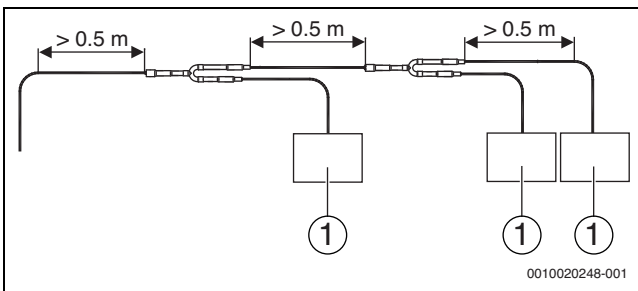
Installazione di giunti di sezione e tubi sul campo
